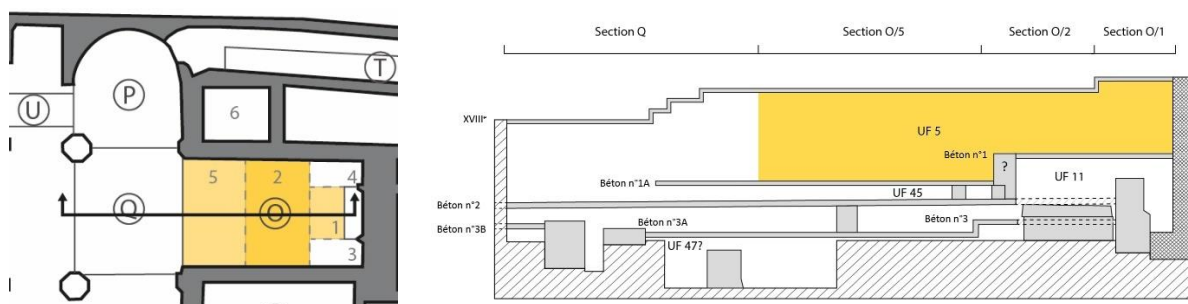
Lieu de découverte des fragments du Lot 1 en plan et coupe (section O/1, O/2, O/5 – UF5)
